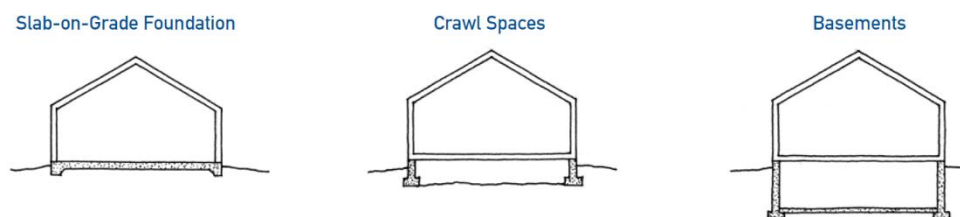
Tipos principais de fundações: pavimento térreo sobre o terreno, pavimento térreo sobre espaço de serviço, e pavimento térreo sobre cave (Thalon, 2009).
